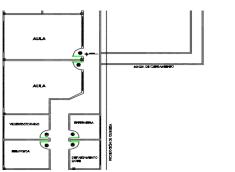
plano arquitectónico de la Unidad Educativa Paul Rivet. Fuente: elaboración Propia.
